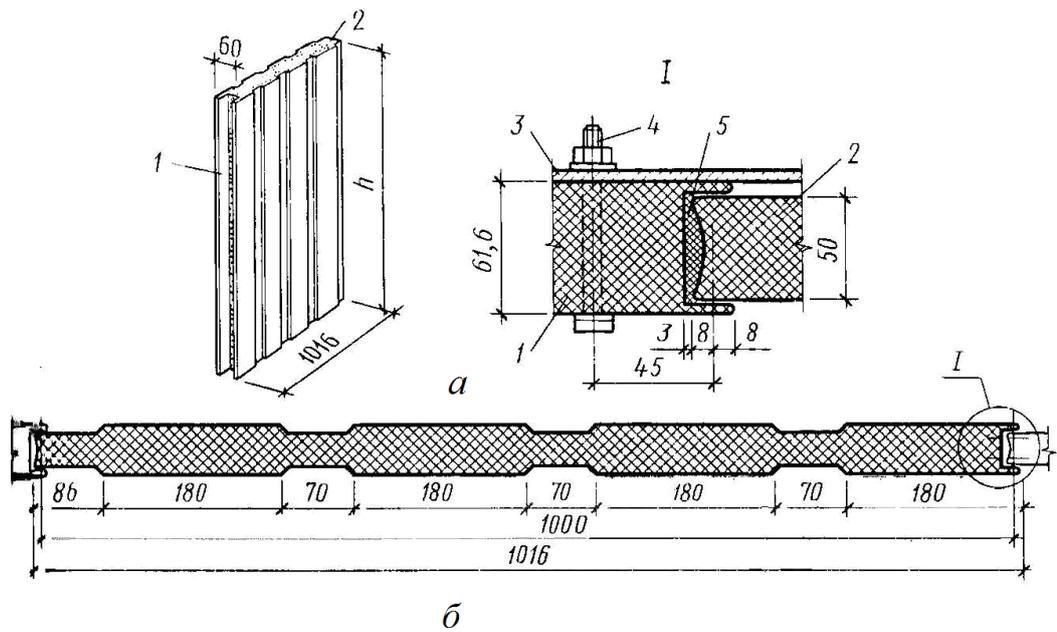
Металлические панели типа «сэндвич» для стен промышленных зданий:
